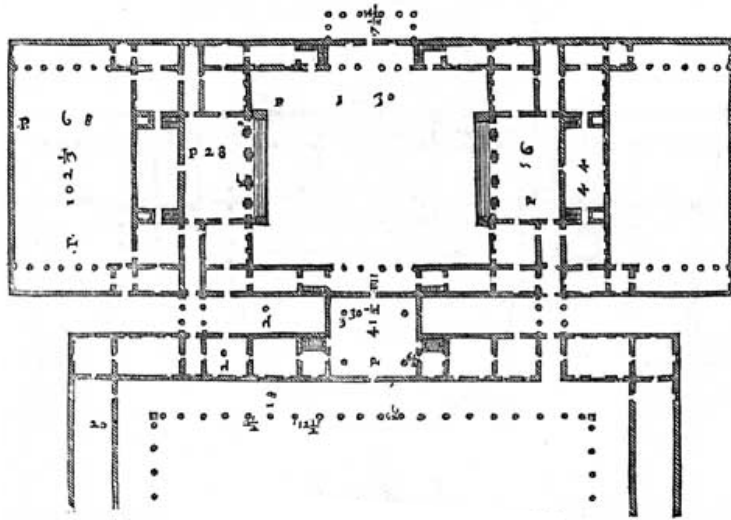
Planta da Villa Thiene segundo Palladio (apud Wittkower).
